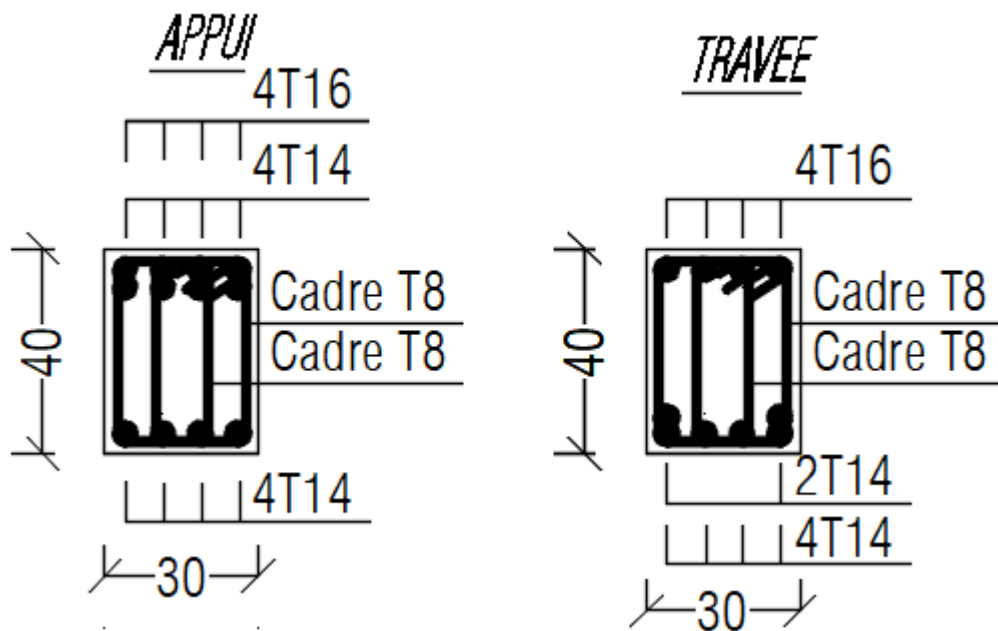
Schéma de ferrailage de poutre principale 30x40.
